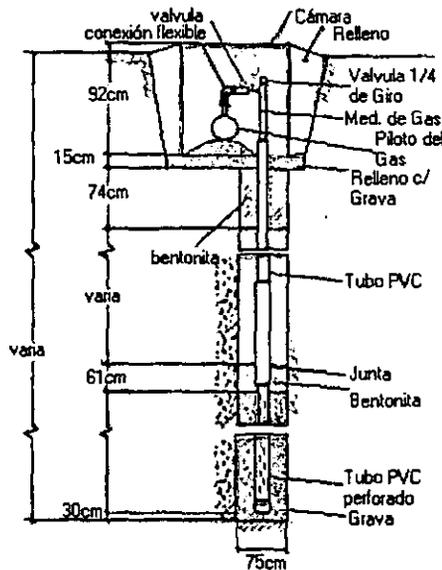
Detalles representativos de un pozo de extracción de biogas
